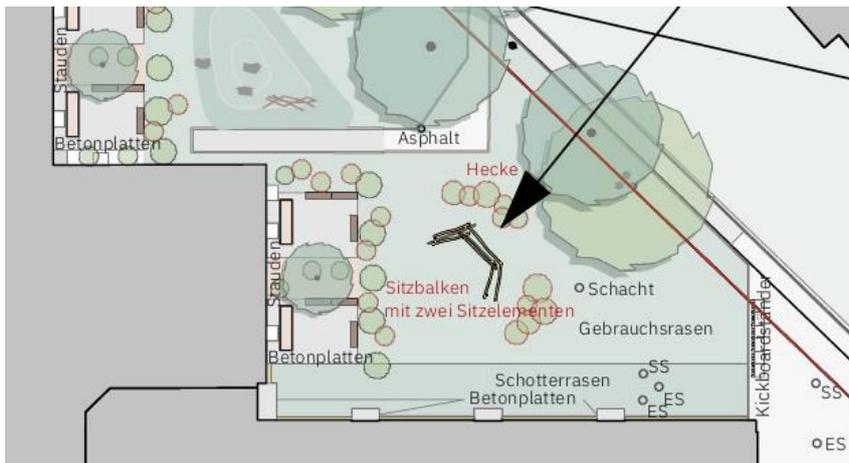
Planausschnitt zeigt neuen Sitzbalken, östlicher Bereich
